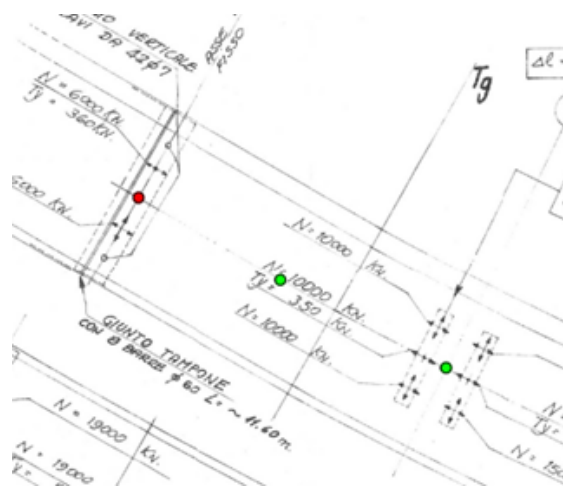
Disposizione dei vincoli su SP1 (a sx) e pila 1 (a dx)
